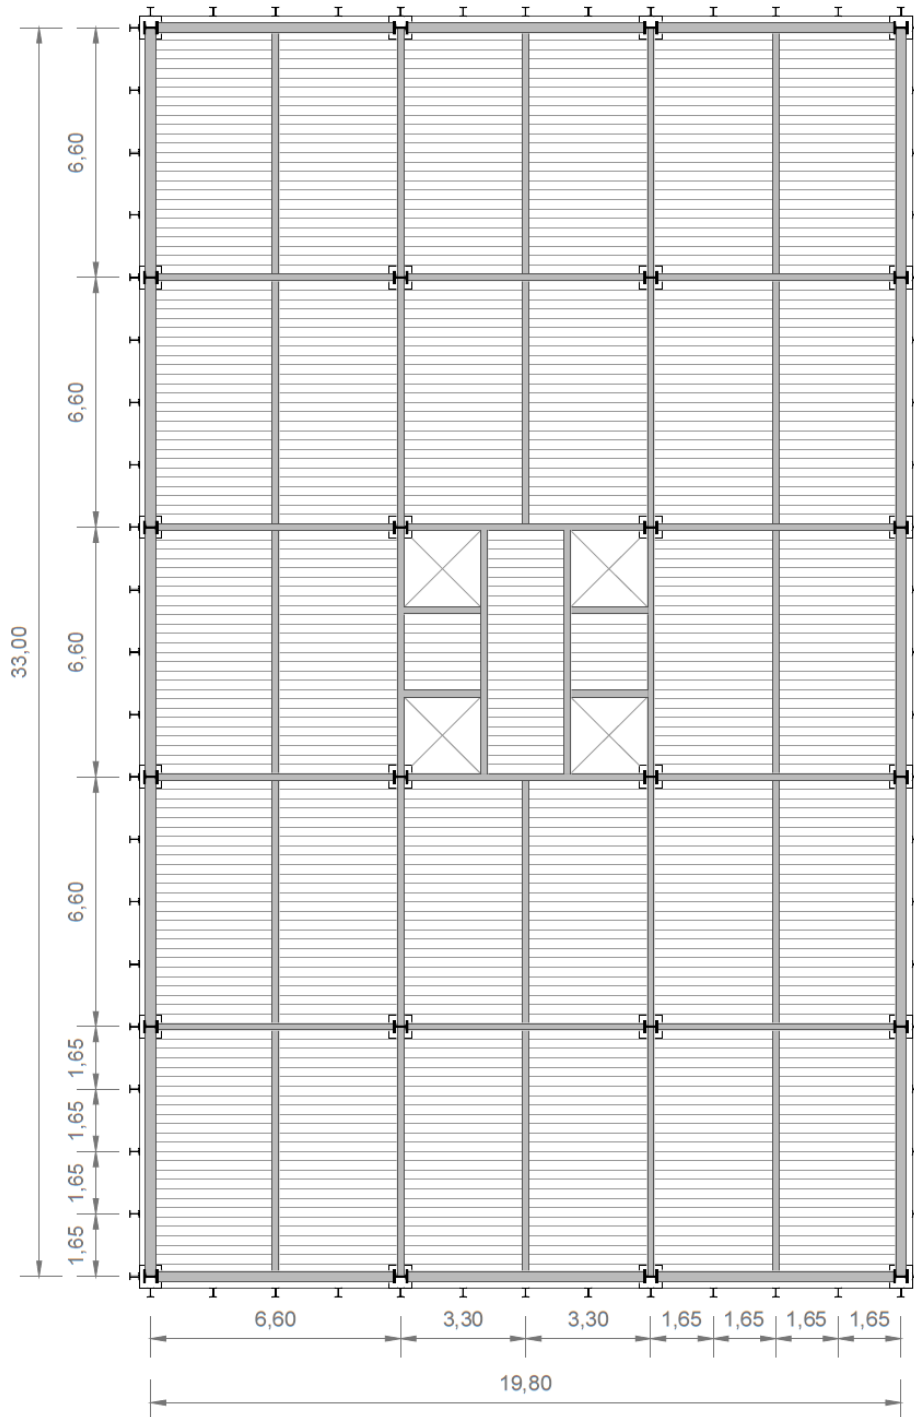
Planta estructural del forjado tipo. Escala 1:200
